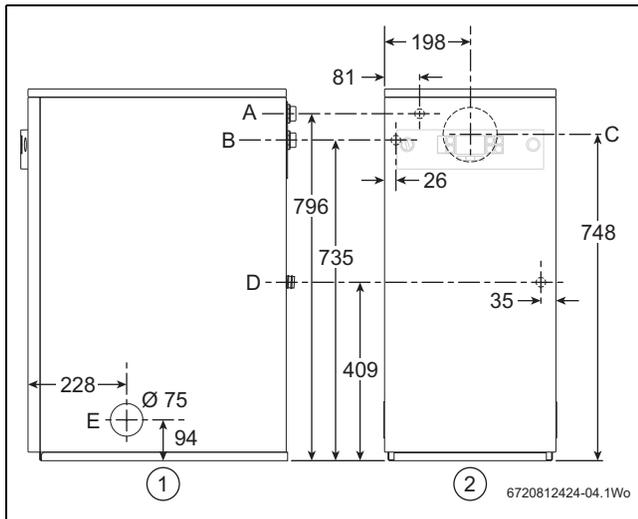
Positions des conduites (toutes les dimensions en mm)
